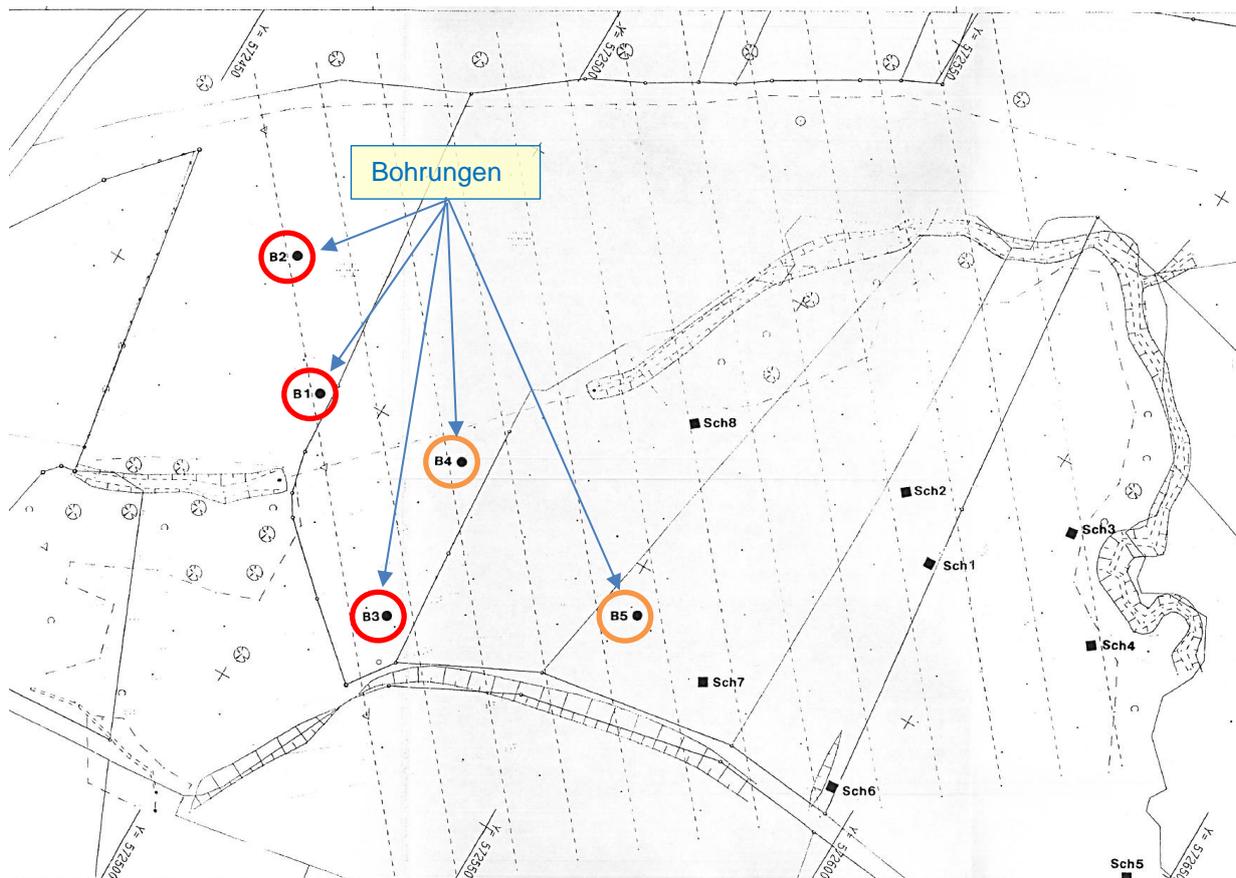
Ausschnitt aus dem Lageplan des Baugrundgutachten
